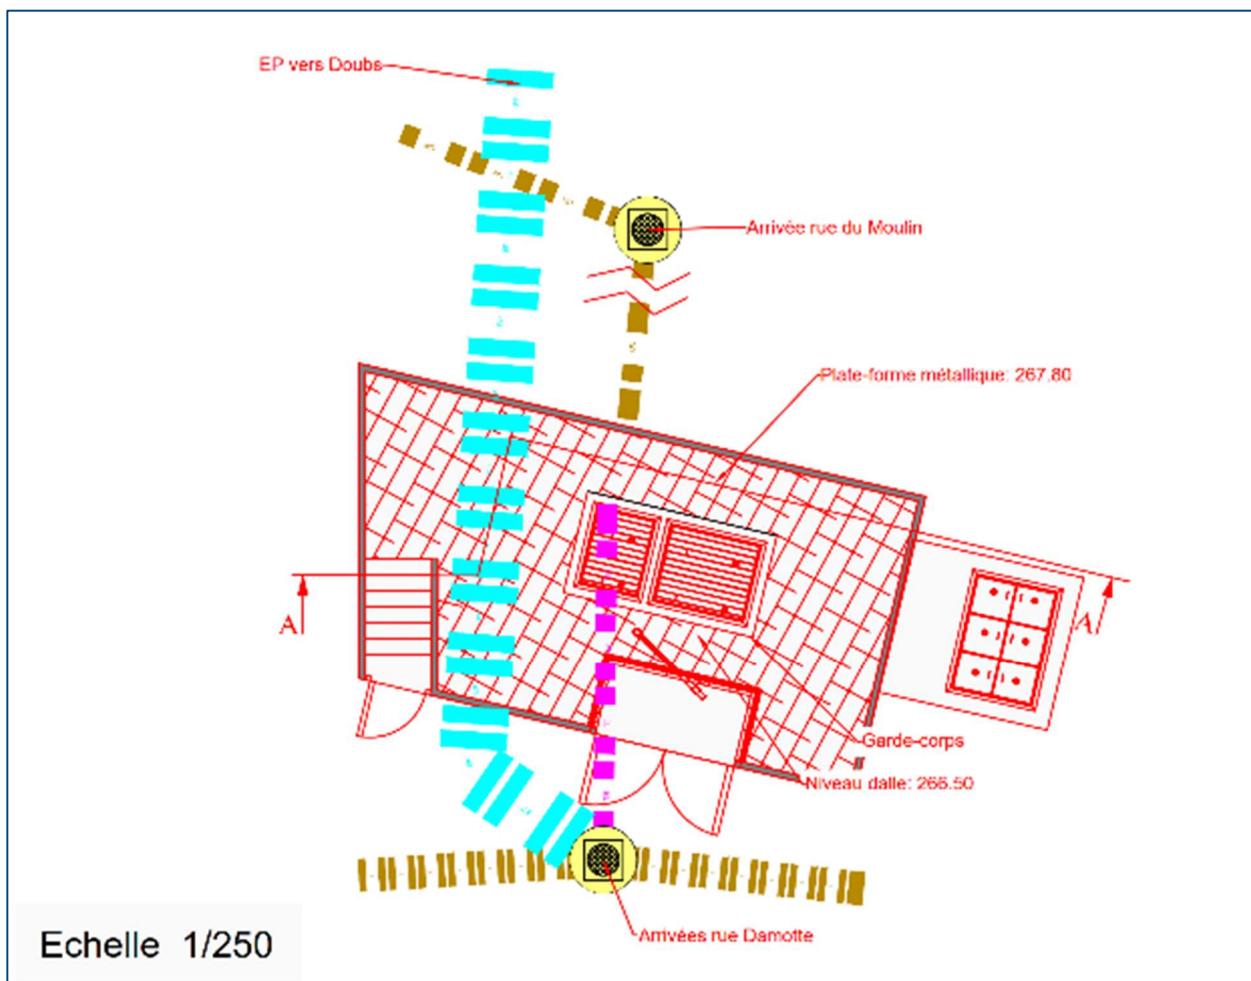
Plan de masse au droit du site d'implantation du PR Cour (plan indicatif)
